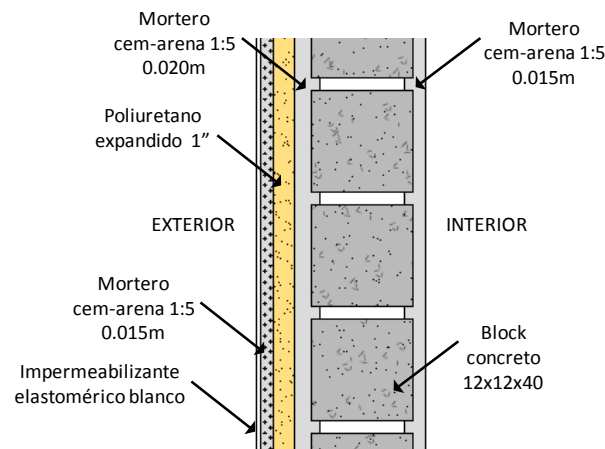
Corte esquemático del aislamiento con poliuretano espolado de 1" en muros exteriores de la fachada sur
